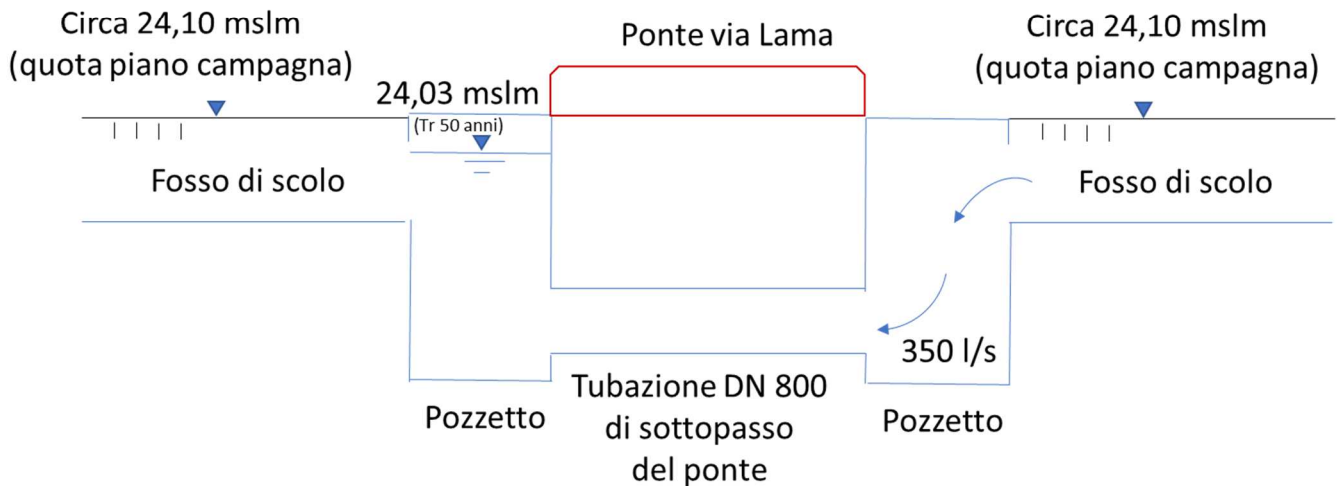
Schema di attraversamento con tubazione DN 800 del ponte su via Lama e quote idriche raggiunte in riferimento alla quota del piano campagna (Sezione A-A indicata in Figura 62)
